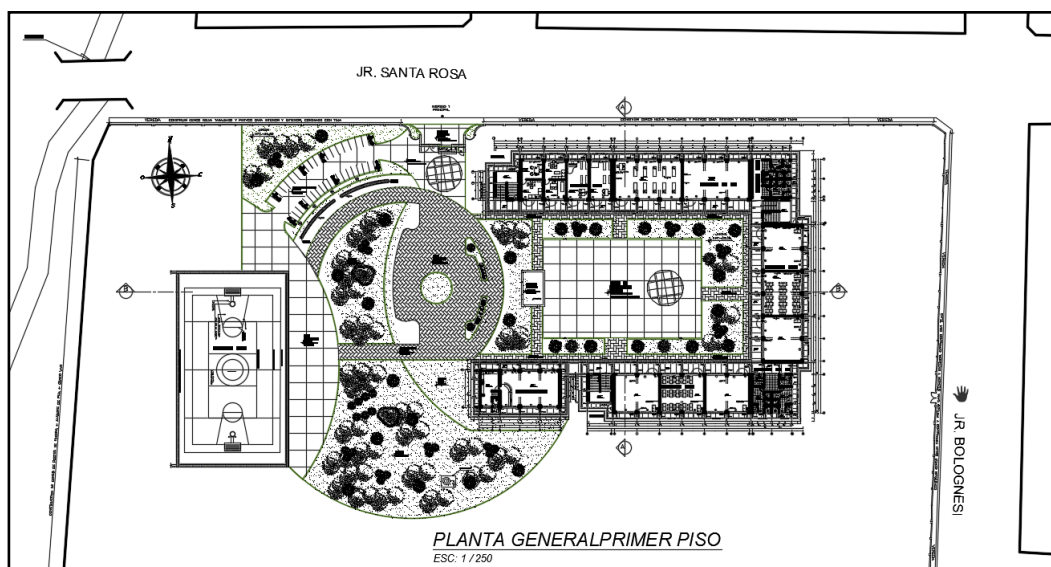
Ubicación del proyecto dentro de su entorno urbano, Planta General Primer Piso. (Fuente: Expediente Técnico del Proyecto. Plano A-01.)
